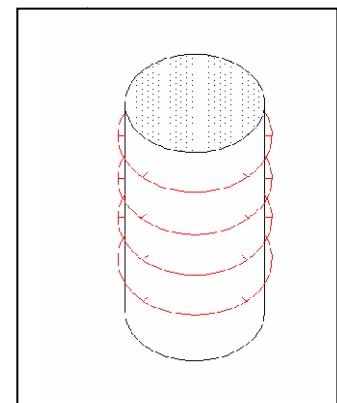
Renforcement des poteaux avec un chemisage en béton armé
